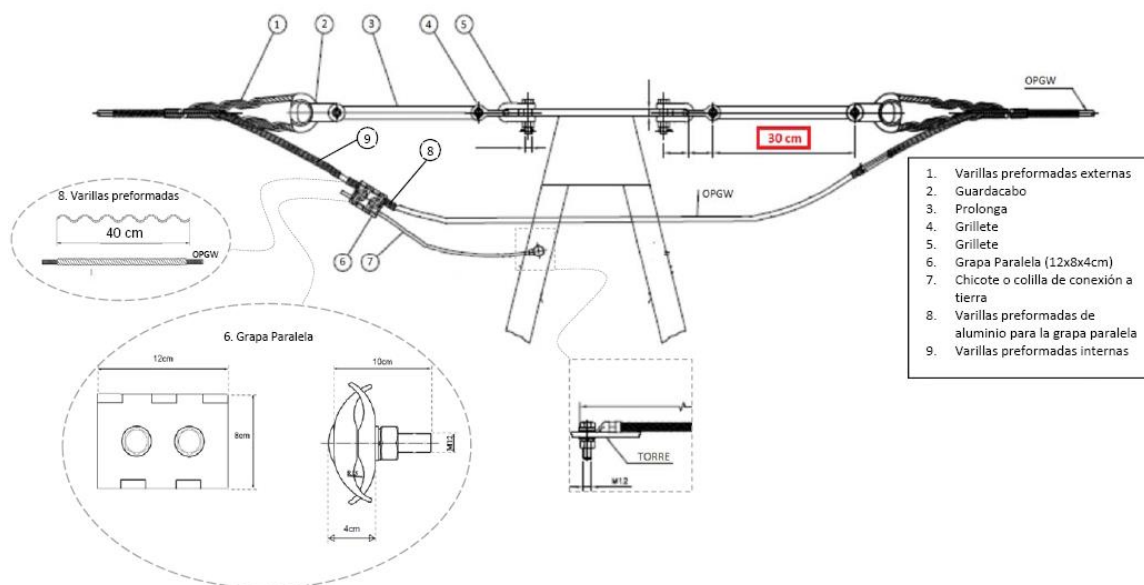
Conjunto de amarre pasante de OPGW para ser instalado en los 2 extremos de la torre
